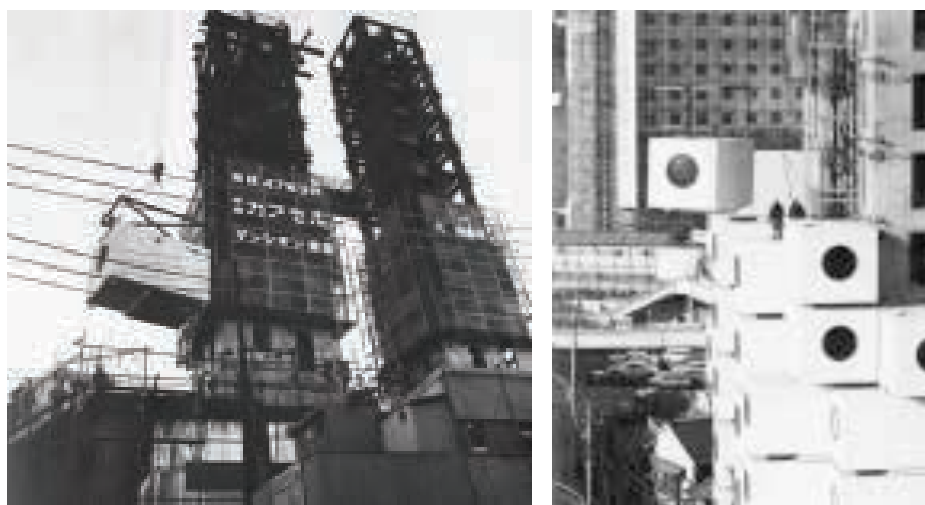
O edifício “Nakagin Tower Capsule Tower” durante a construção, Kisho Kurokawa, 1971
